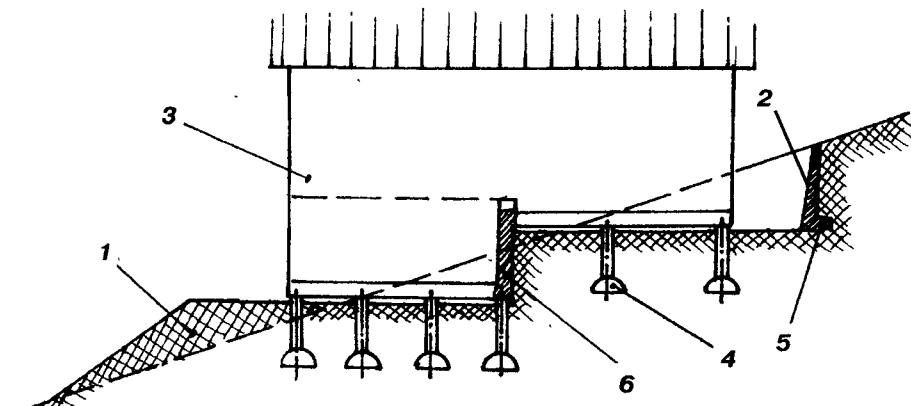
Устройство двухуровневой строительной площадки на склоне:
